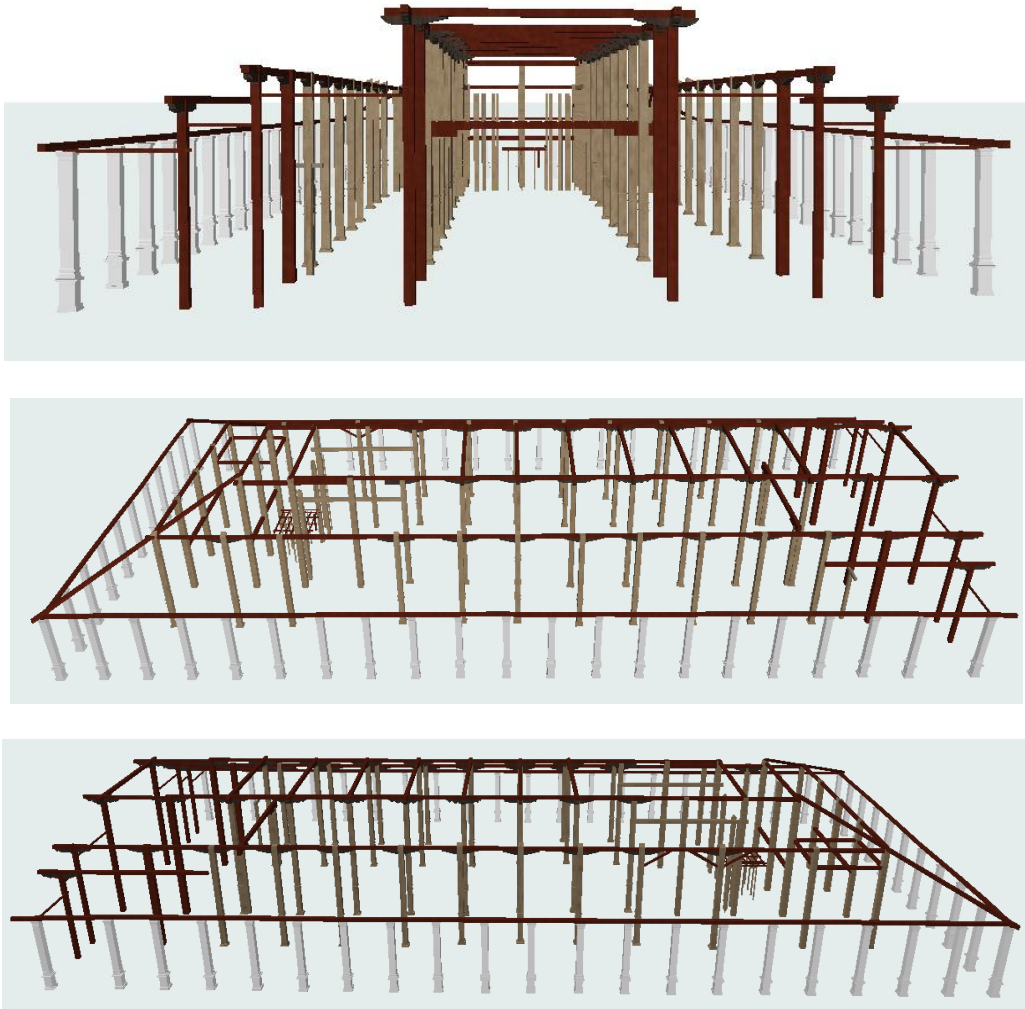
Elementos estructurales en la vista trasera del Templo San Buenaventura
